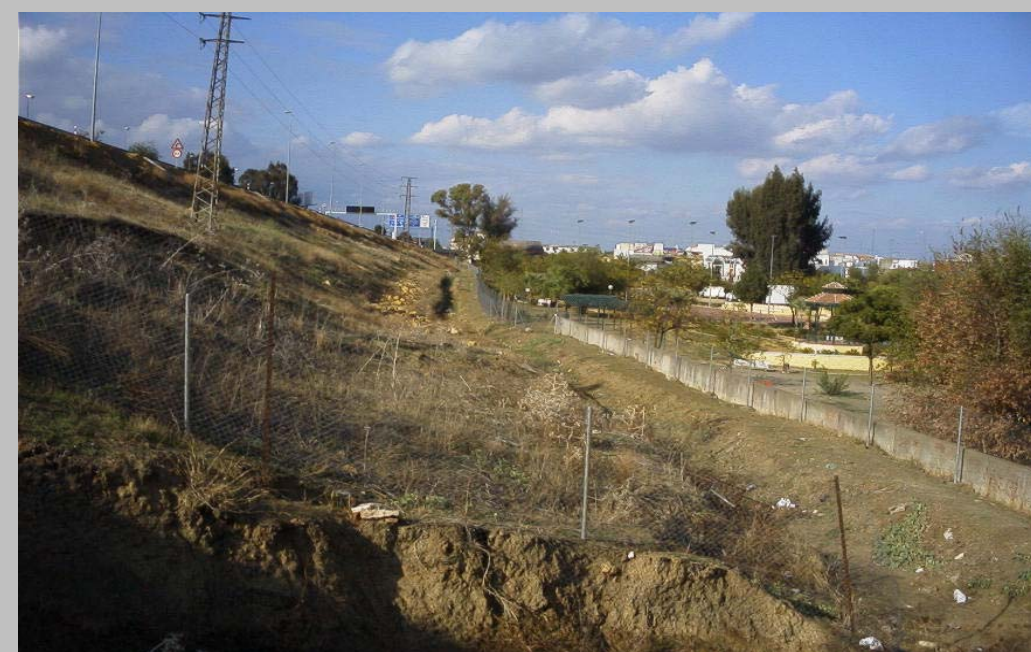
Cuneta pie de terraplén en tierras en la margen de la A-49.
